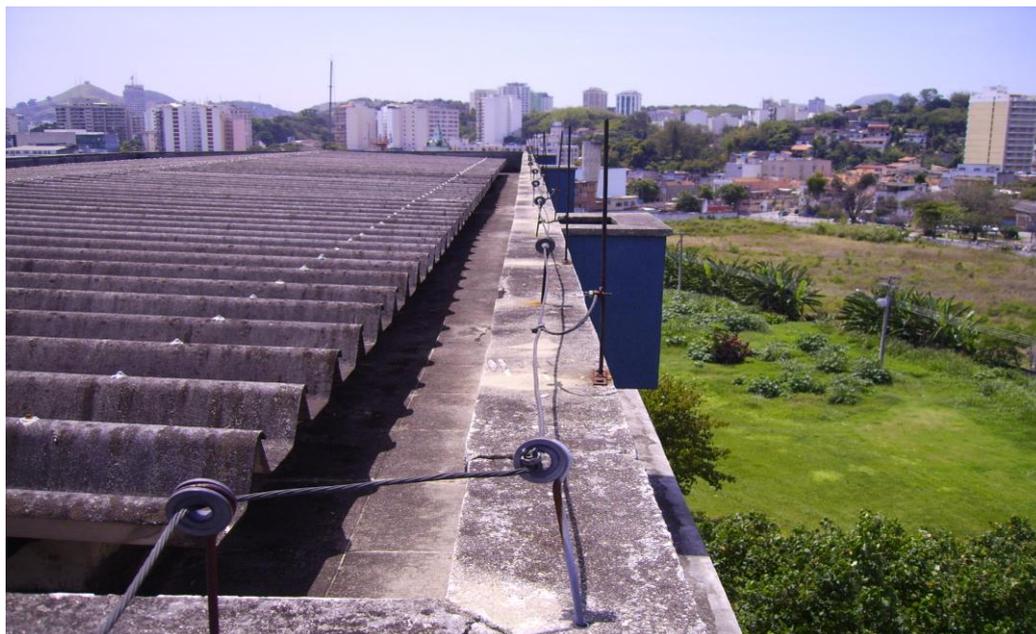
Vista parcial da parte de cima da cobertura, mostrando o plaqueado da proteção mecânica sob a impermeabilização das calhas em concreto e a fiação do para-raios do prédio do bloco “O”
